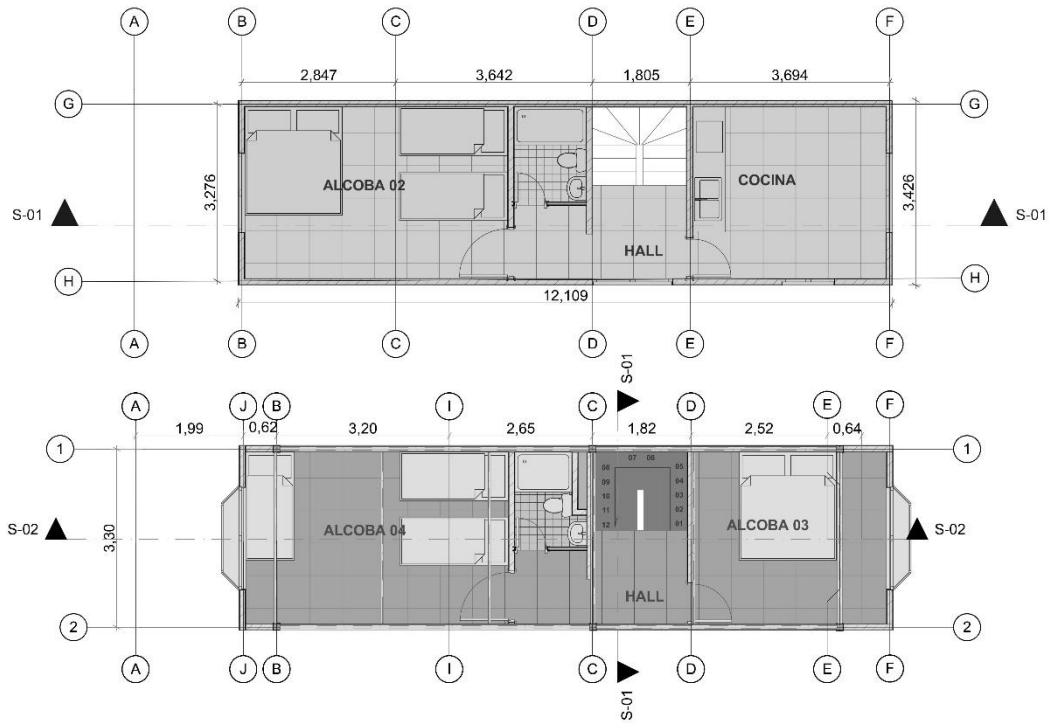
Plantas de tercer piso existente y propuesta, indicando nueva espacialidad. Elaboración propia 2017.
